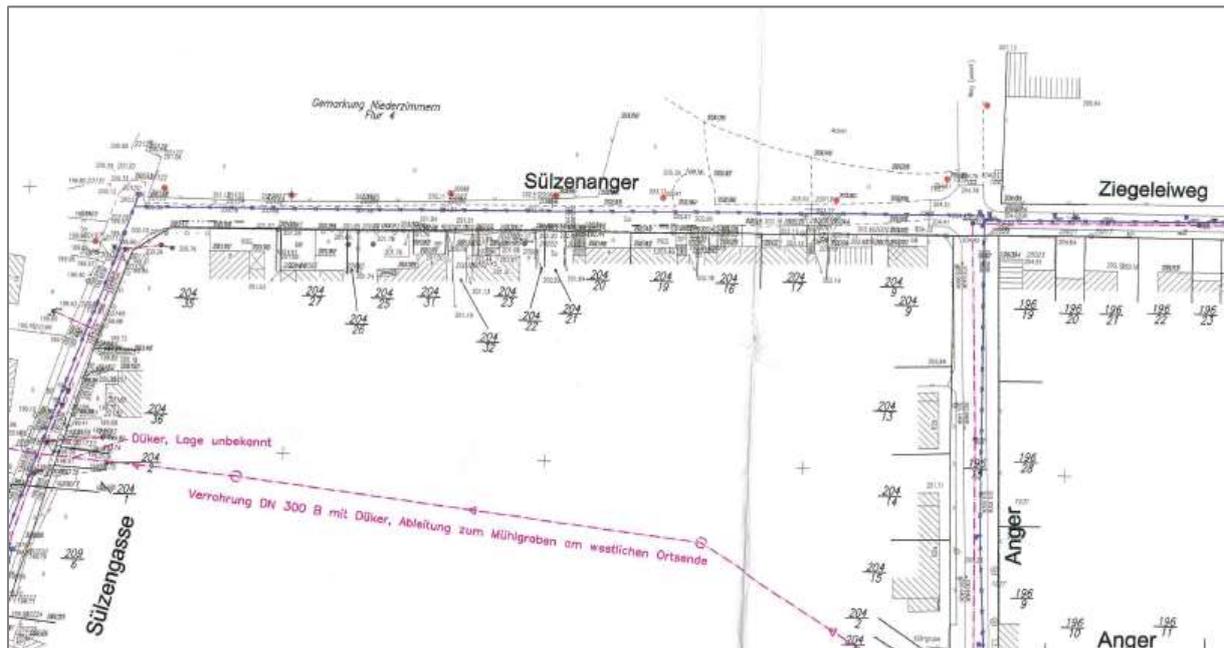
Lageplan des Abwasserverbandes Grammetal
